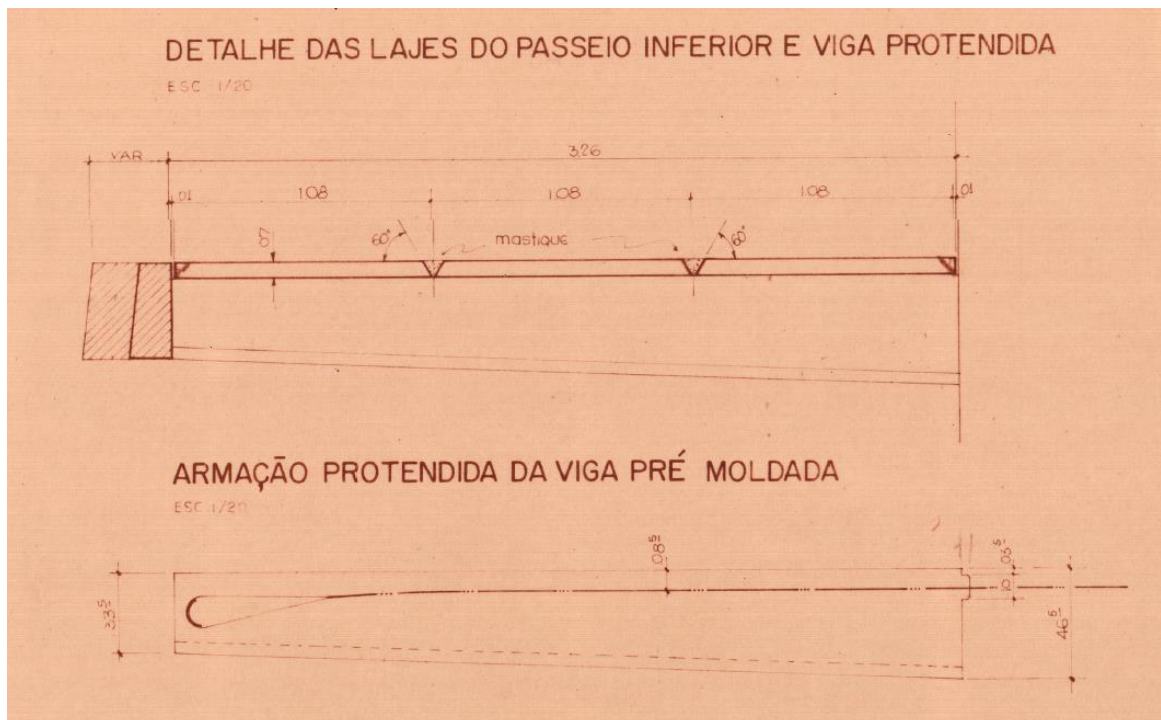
Detalhe das lajes do passeio inferior e viga protendida. Armação protendida da viga.
